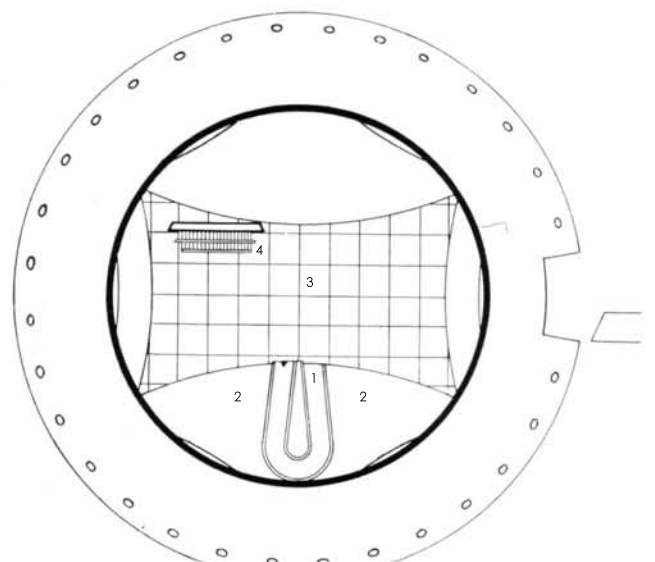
3.º PAV. - PLANTA BAIXA
